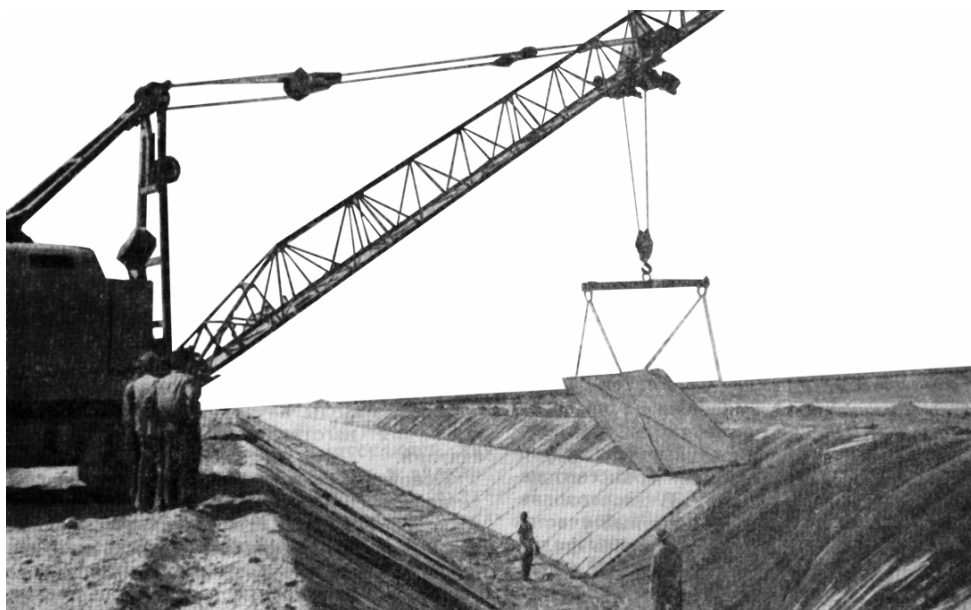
Облицовка русла канала железобетонными тонкостенными плитами по полиэтиленовой пленке (Духовный, 1981 г.)
